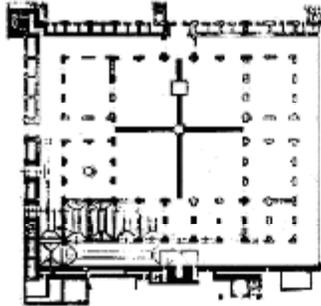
مسقط أفقي لجامع الكتبية الأول بمراكش
